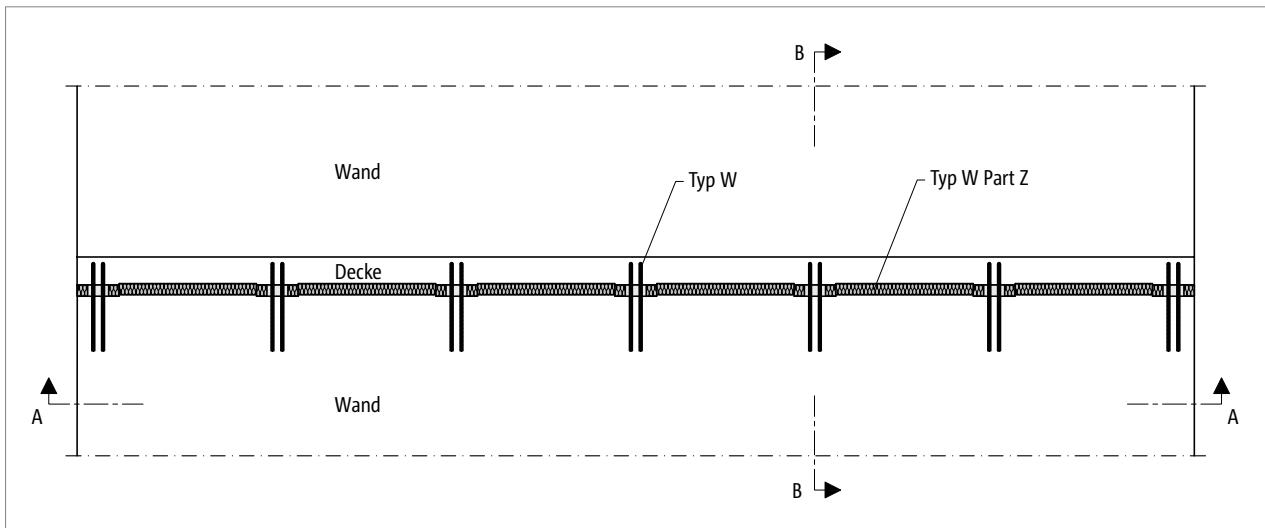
Schöck Sconnex® Typ W: Anschluss zwischen Wand und darüberliegender Decke – Einbau am Wandkopf
